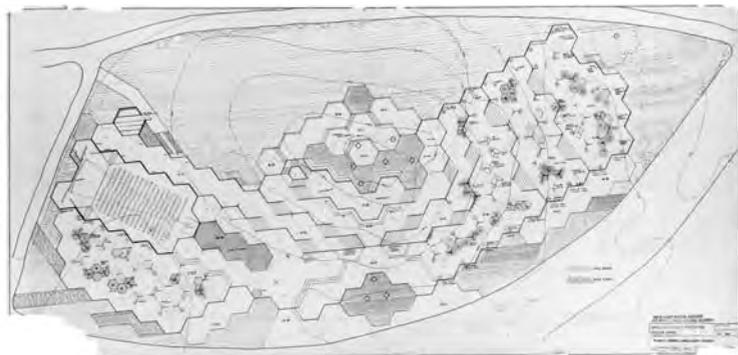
Planta de la instalación interior. (imagen del Archivo de los arquitectos).
